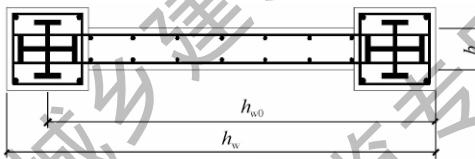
带边框型钢混凝土剪力墙斜截面受剪承载力计算参数示意
